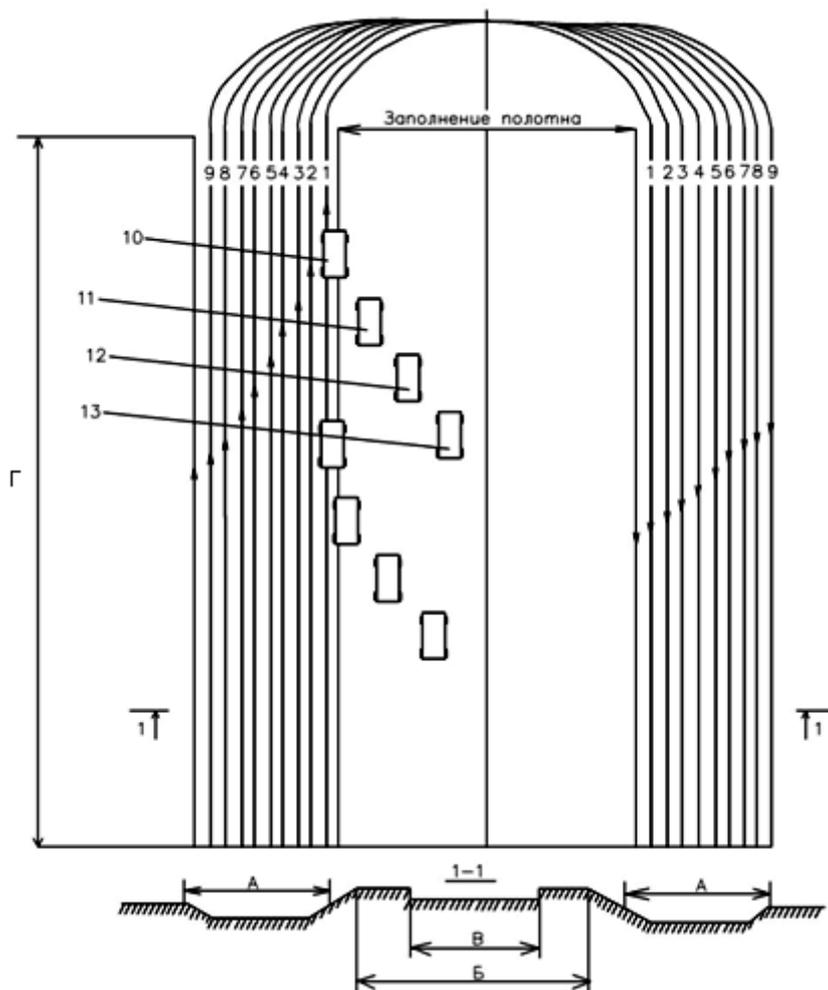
Схема возведения насыпи из боковых резервов:
